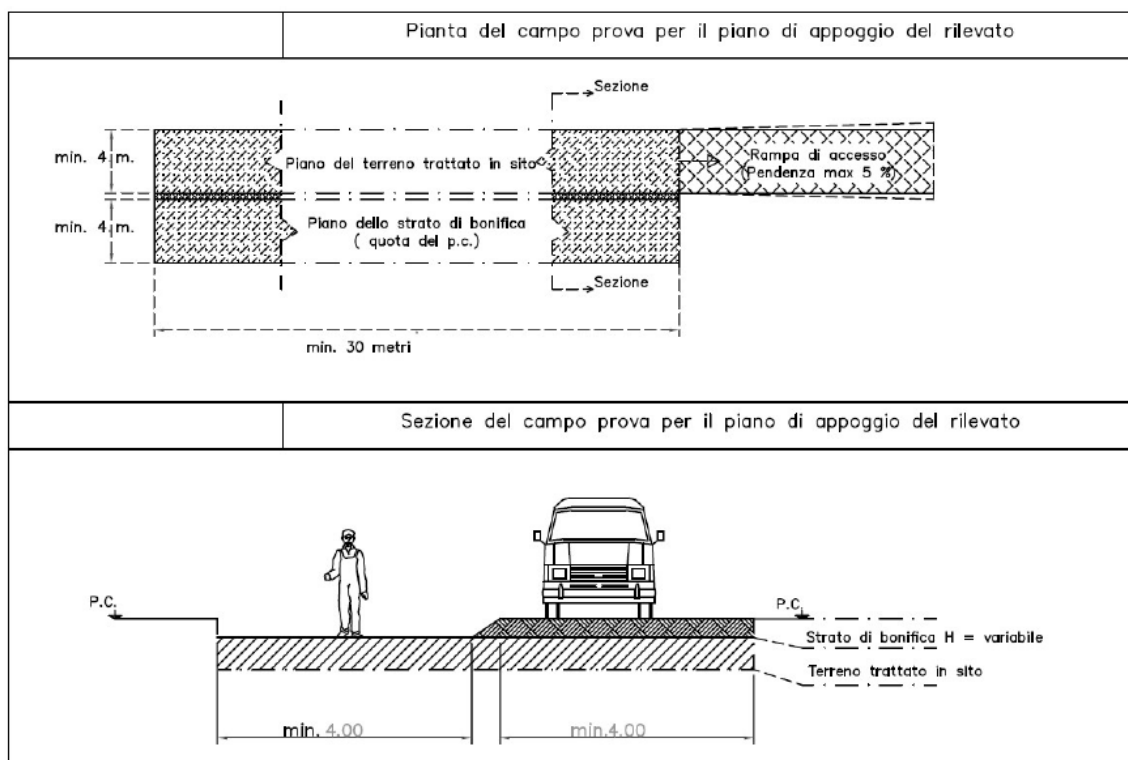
Schema in pianta ed in sezione per il piano di appoggio del rilevato
